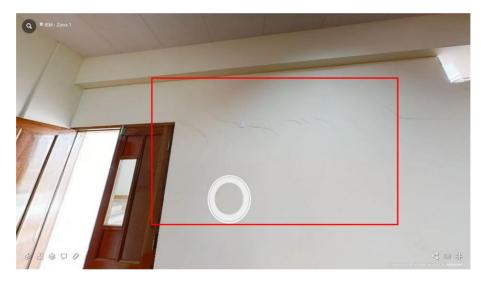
Sala de Reuniones (Fisuras)
